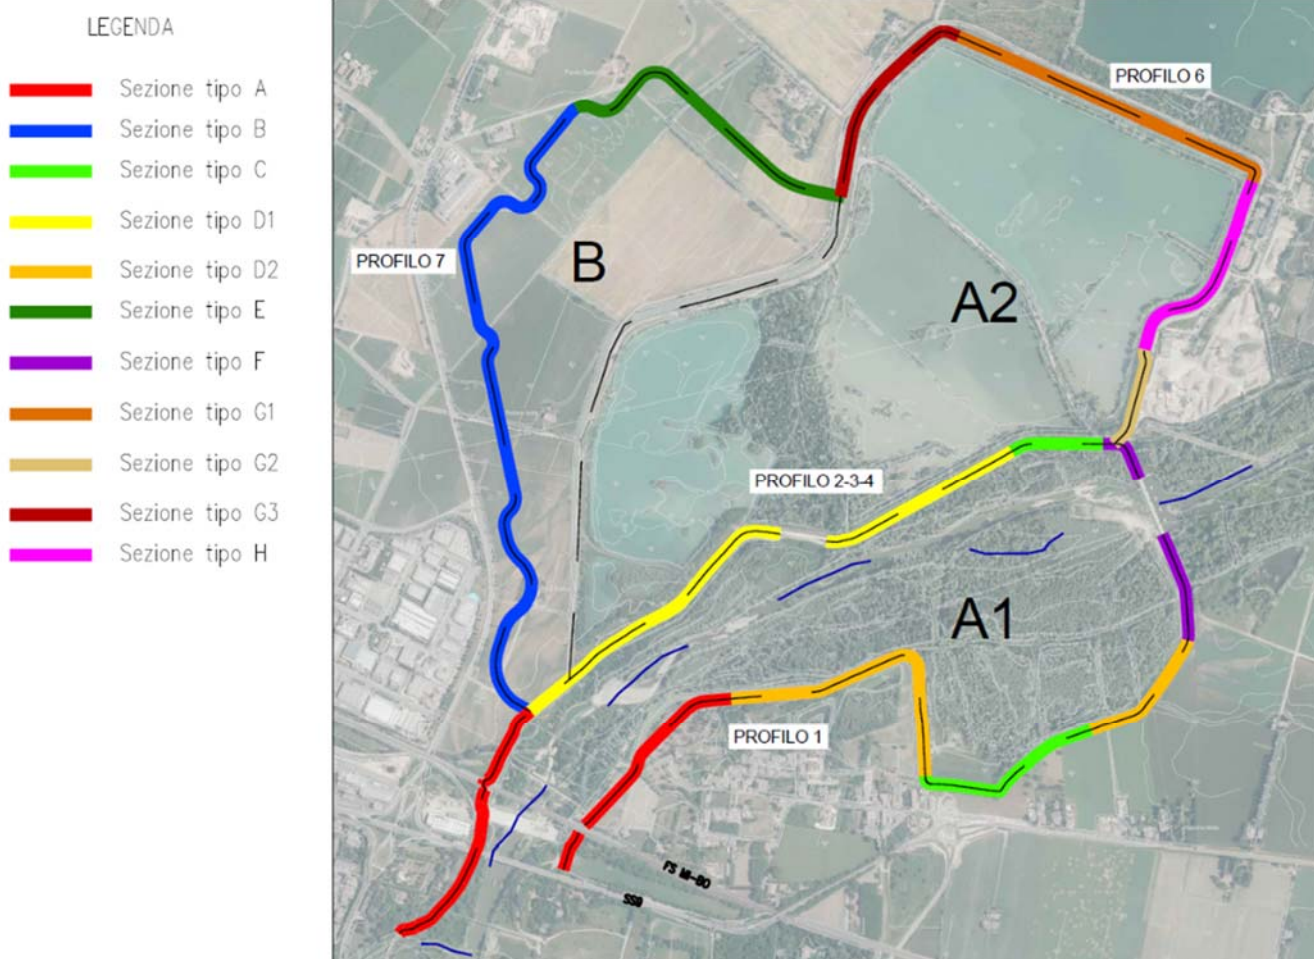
Ubicazione in pianta delle sezioni di verifica
